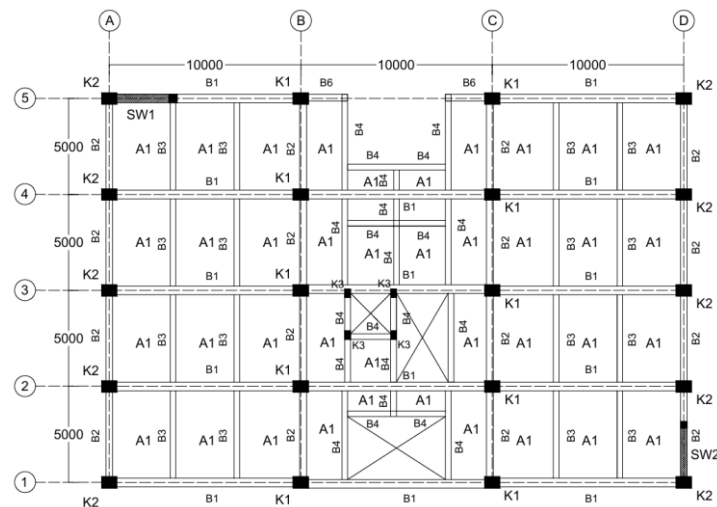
Denah lantai 1-3 gedung eksisting (model 1)
